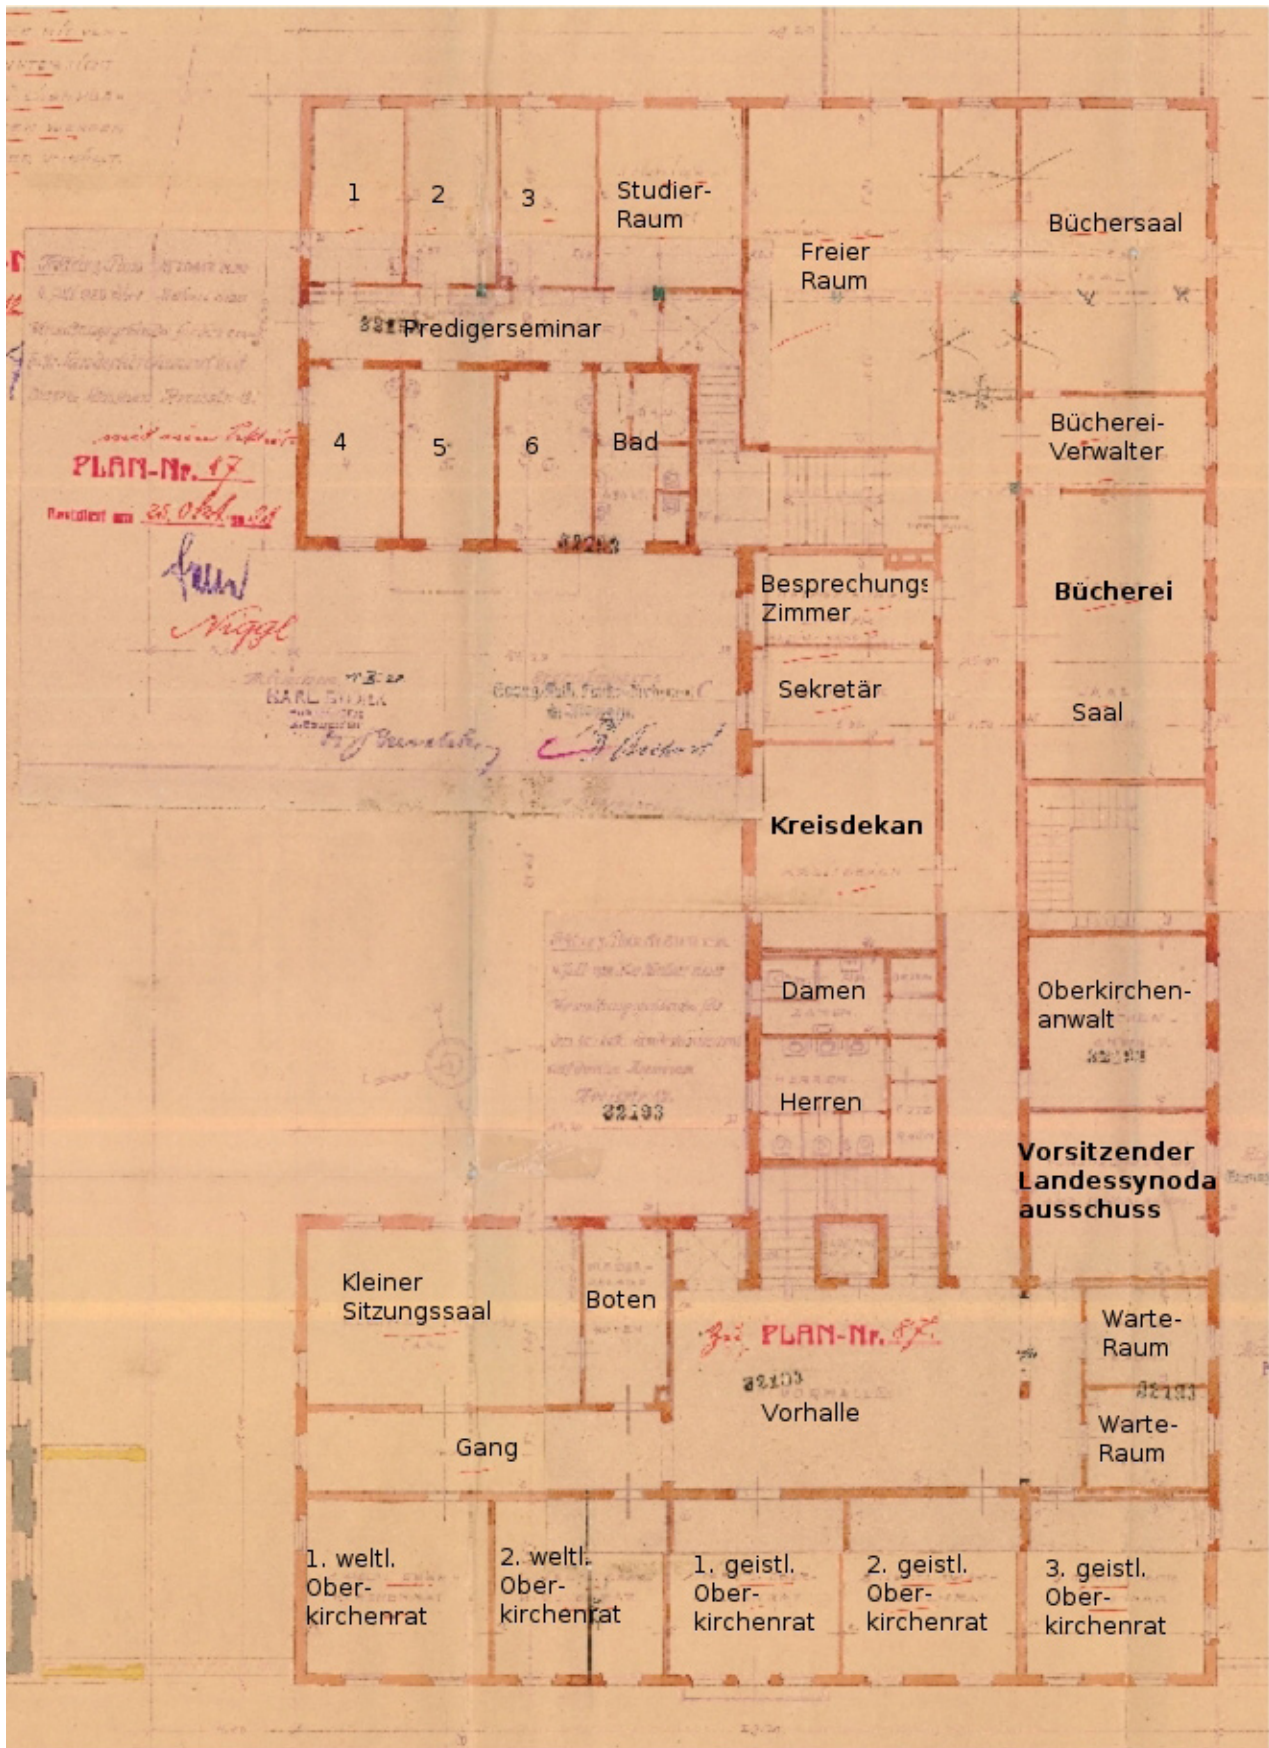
Grundriss 1. Obergeschoss
